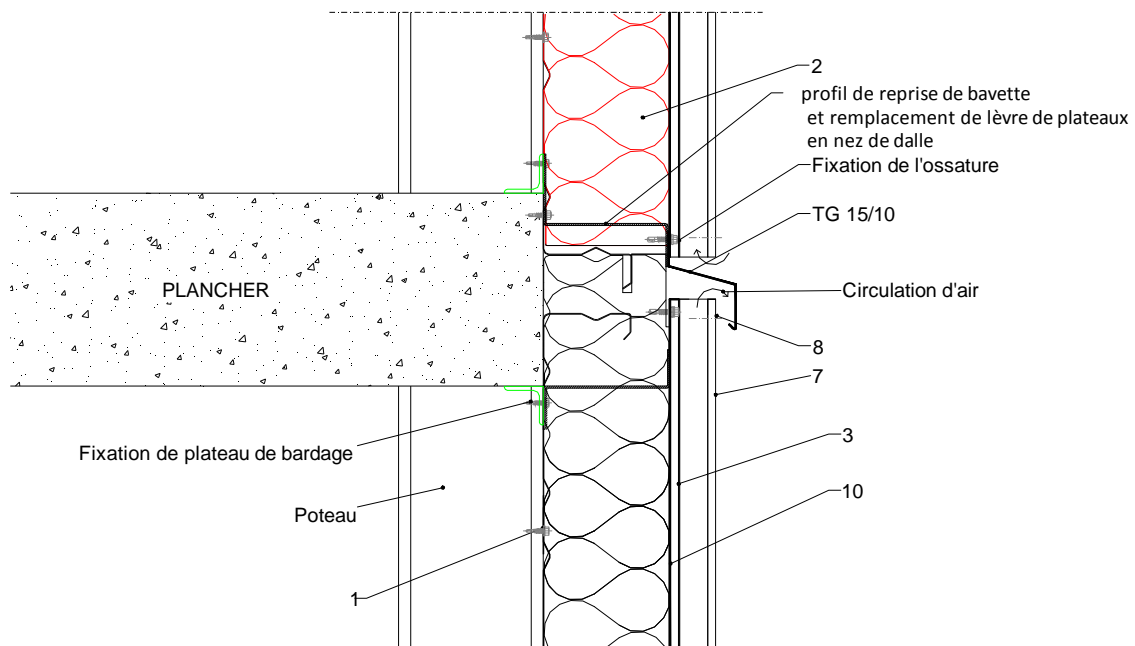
Fractionnement au droit de chaque plancher en zone sismique – Coupe verticale
